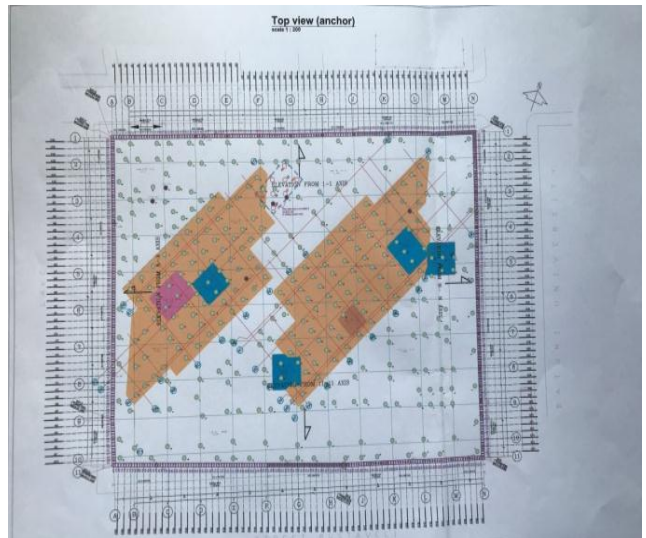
Устройство котлована, свайного поля (на плане отмечены сваи подлежащие испытанию) и контурных анкеров гостиницы «HILTON» в г. Батуми
